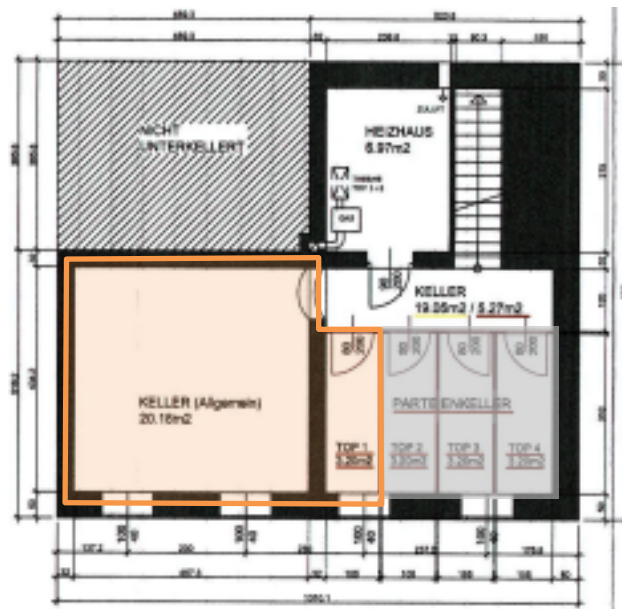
Grundriss Teilkeller – Eigenkeller 1 und Lager 1 (Auswechslungsplan 28.02.2014)
